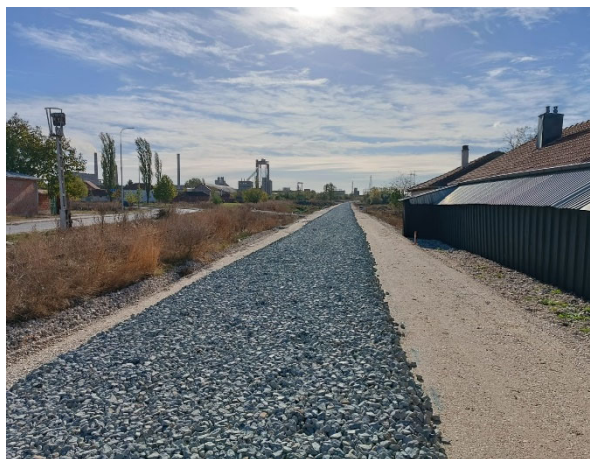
Vendosja e shtresës së parë të ballastit Figura 34 Vendosja e shinave dhe traversave
